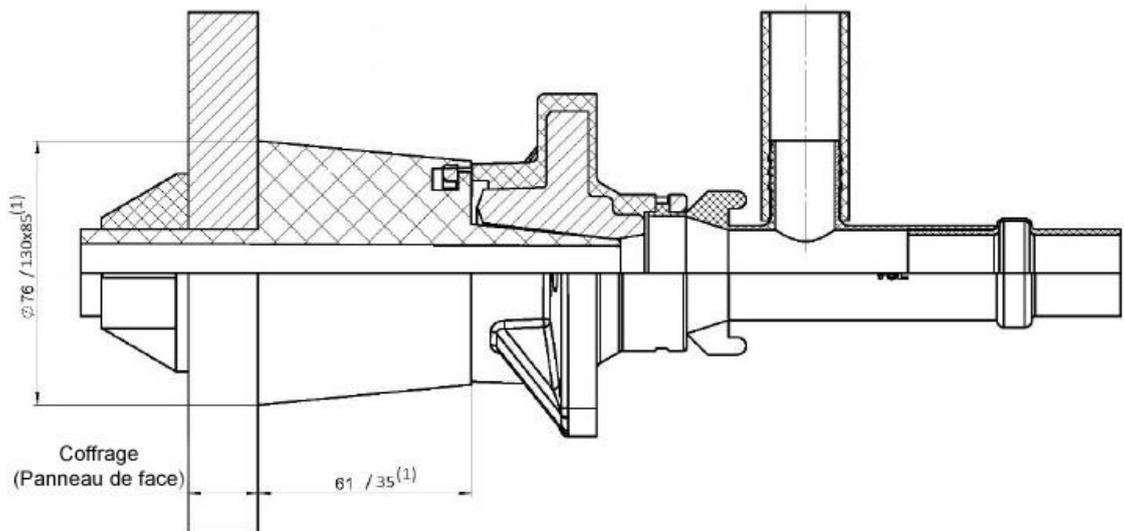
Ancrages type S 6-1 PLUS – Dimensions du dispositif d'installation
